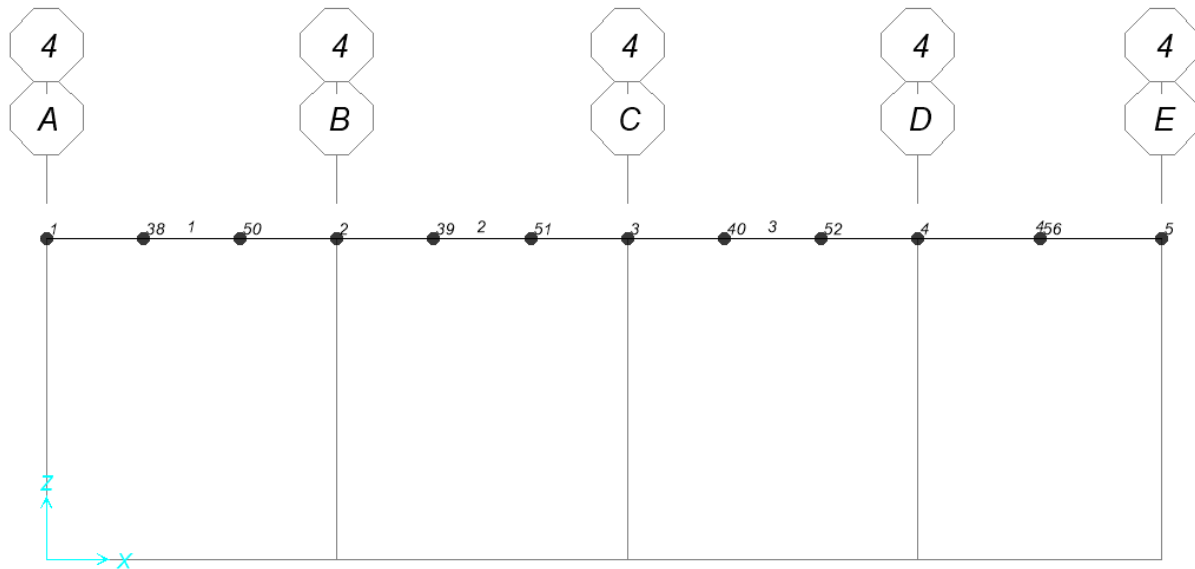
Vista in sezione modello struttura in elevazione –Filo 4 - numerazione elementi frame e joint
